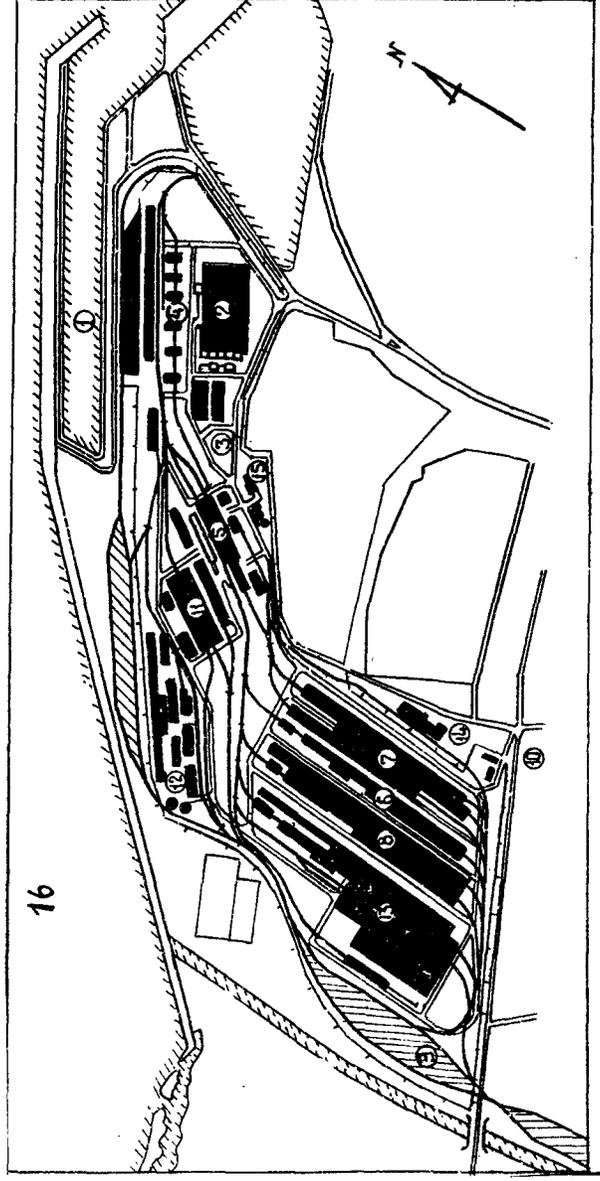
Завод фирмы ИВМНОР в Донкерке (Франция): 1 - внутренняя галерея; 2 - усреднительный склад; 3 - агрегативная фабрика; 4 - доменный пех; 5 - кислородно-конвертерный пех № 1; 6 - алюминат-онофанг; 7 - толкательный стан; 8 - непрерывный широкослойный стан горячей прокатки; 9 - сортировочная станция; 10 - заводоуправление; 11 - кислородно-конвертерный пех № 2; 12 - коксохимический пех (вторая очередь строительства); 13 - территория для расширения прокатных цехов; 14 - трубный пех; 15 - хозяйство водоснабжения; 16 - Северное море
